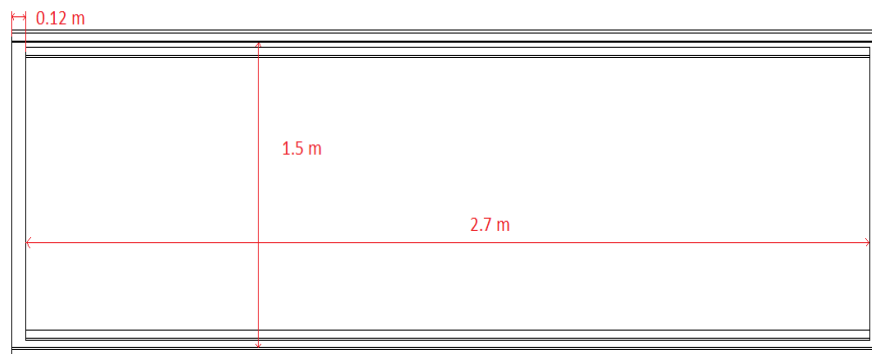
Acotación de las ventanas fachada Norte.
